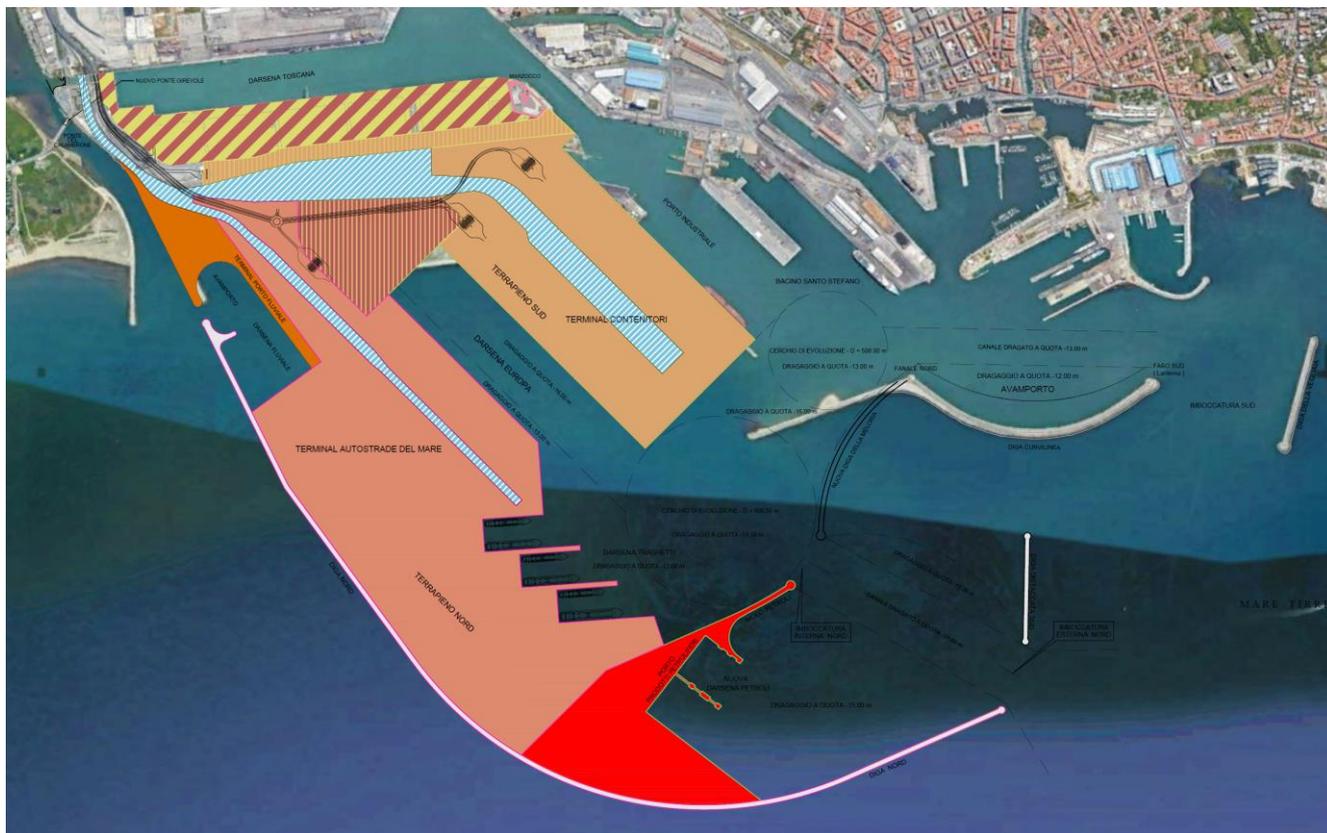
planimetria generale – sovrapposizione ATF con stato attuale
